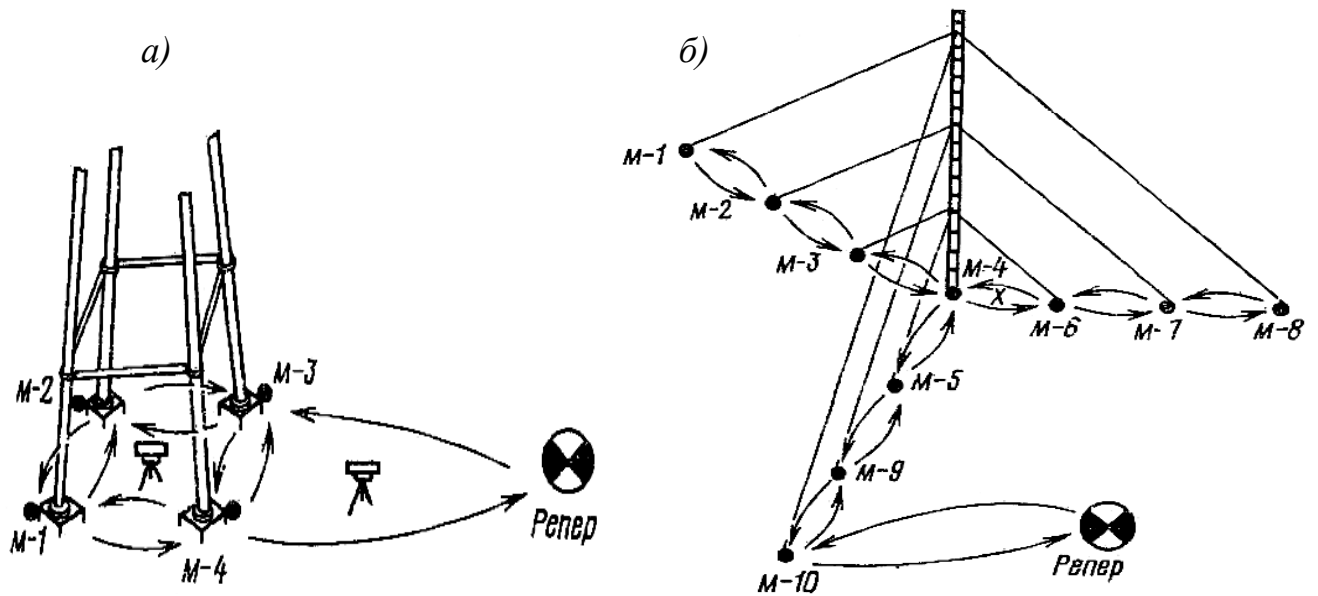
Типовая схема нивелирных ходов при контроле осадок фундаментов башни (а), ствола и анкерных фундаментов мачты (б)
